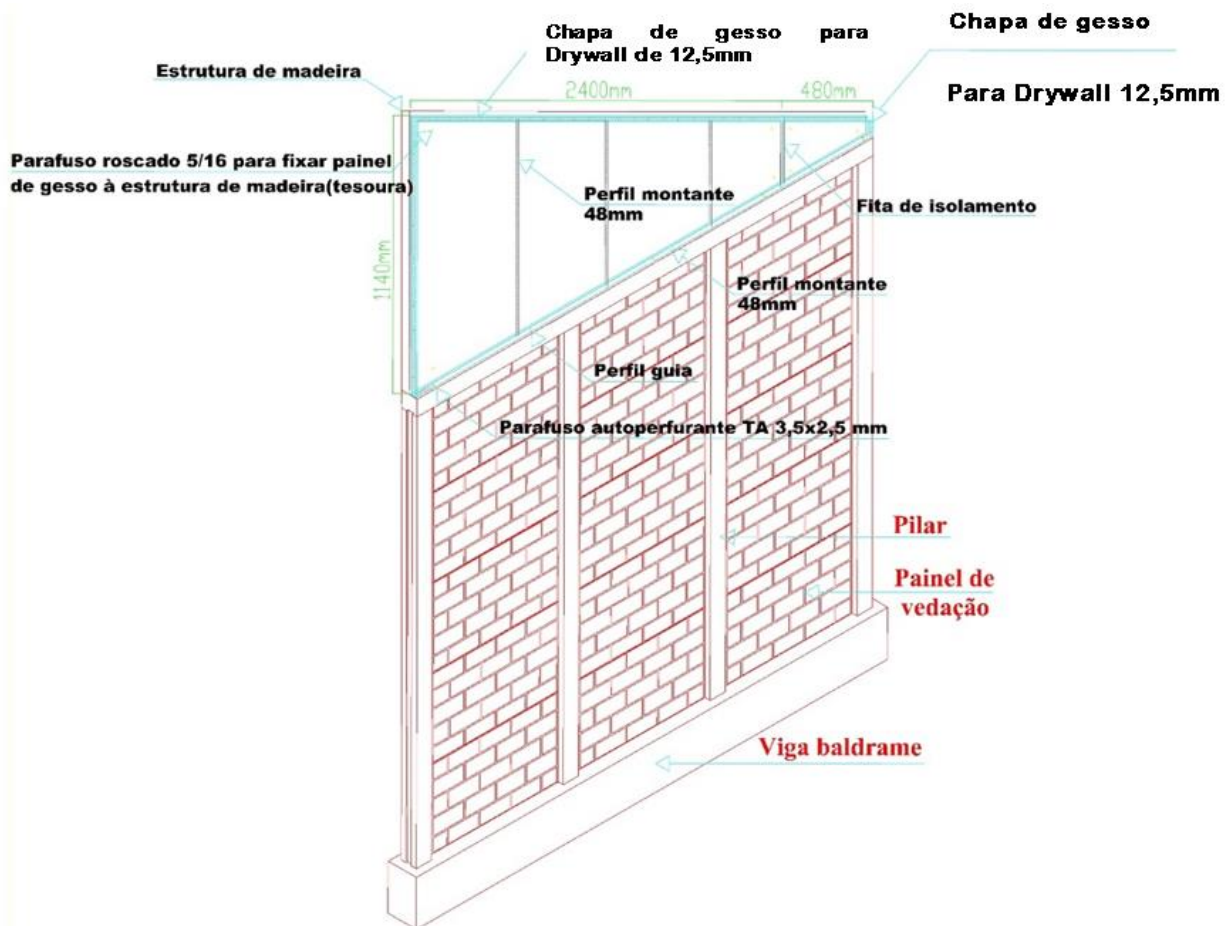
Detalhe - interface da viga baldrame e painéis em concreto pré-moldado.
